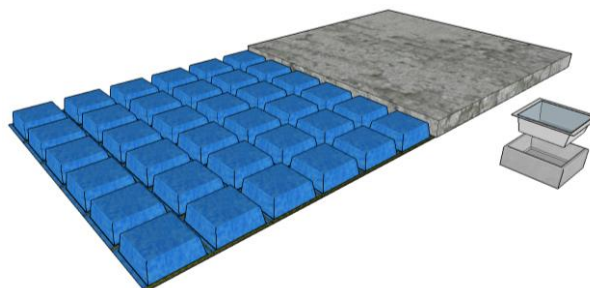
Detalhe construtivo de Laje Nervurada e cubeta.
